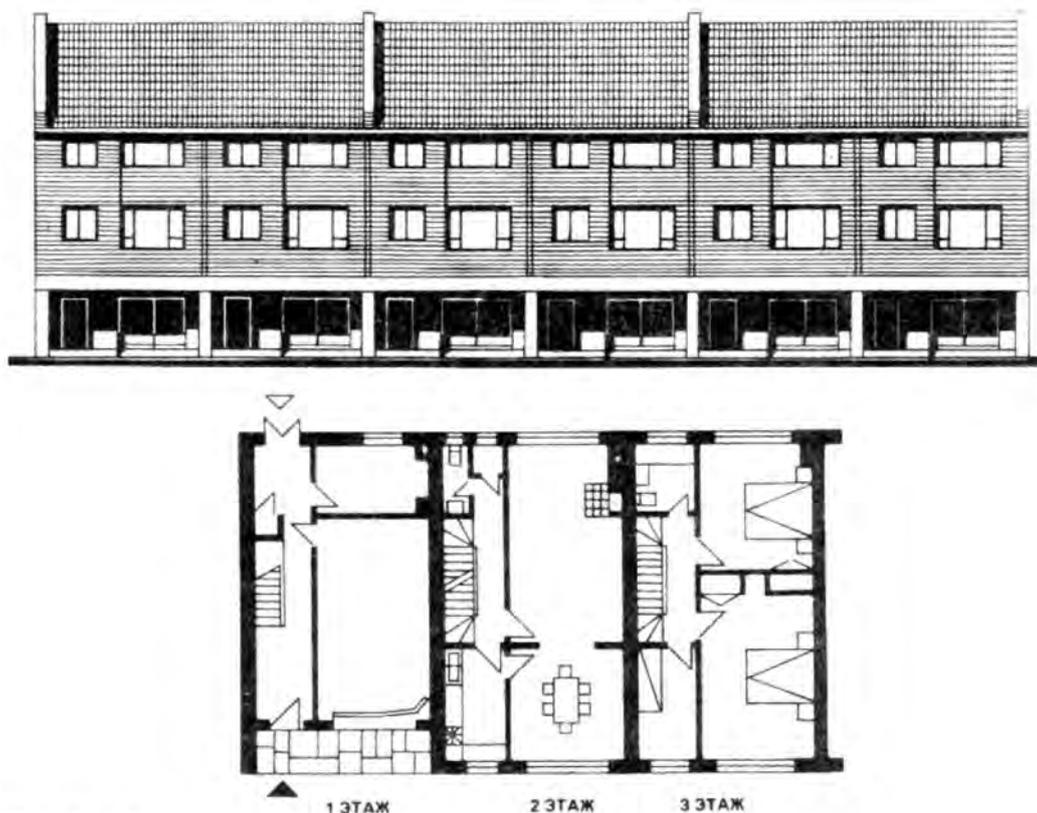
Трехэтажный блокированный дом с расположением в первом этаже гаража и хозяйственных помещений, в верхних — жилых комнат (Англия)
